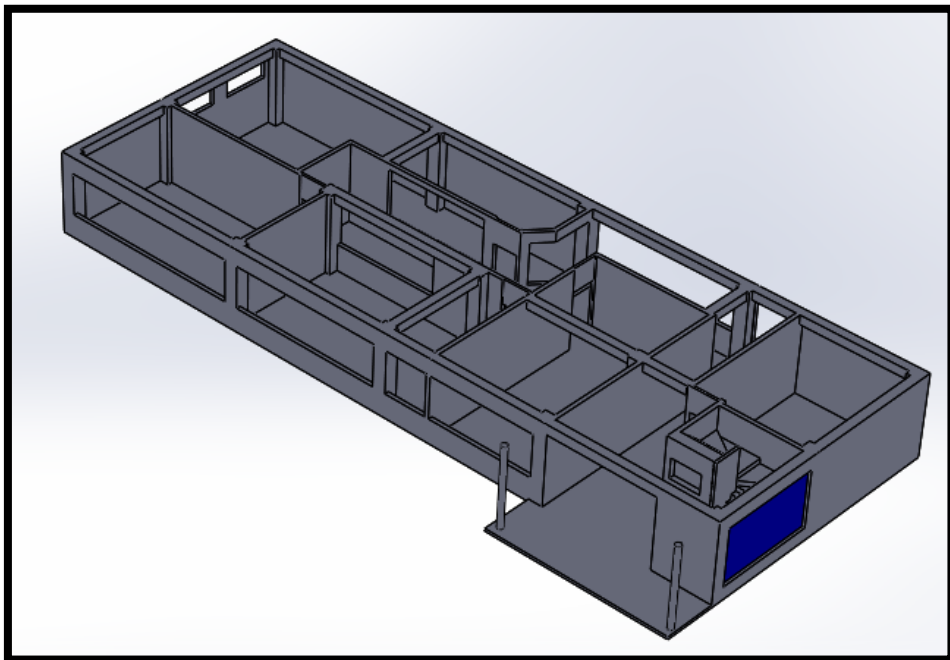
Planta baja diseñada en SolidWorks con las respectivas dimensiones.
